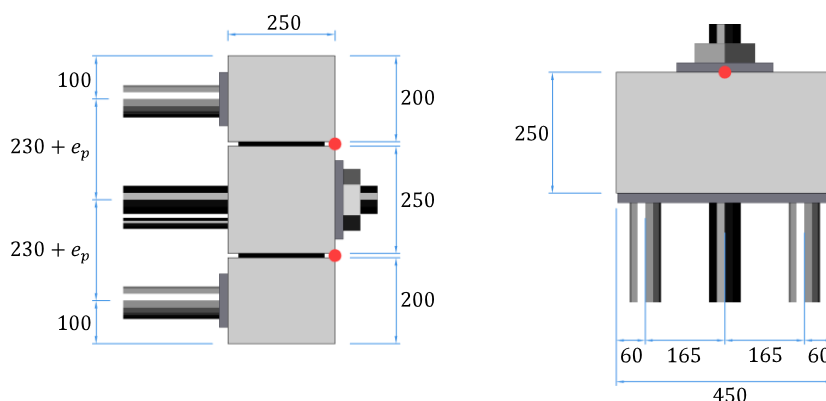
a) Vista en alzado y b) vista en planta de la posición de los sensores de desplazamiento (●)
